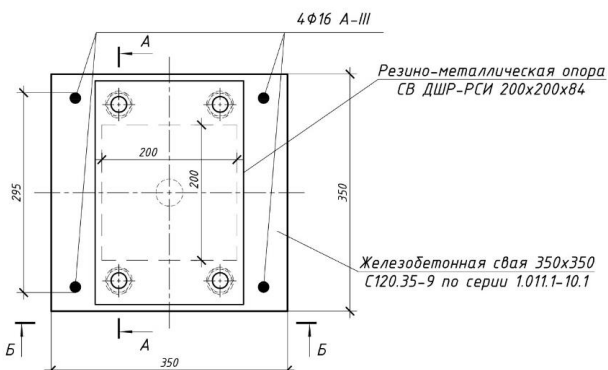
Узел сопряжения резинометаллической опоры СВ ДШР-РСИ СО 200×200×84 с конструкциями железобетонной сваи и фундаментной плиты
